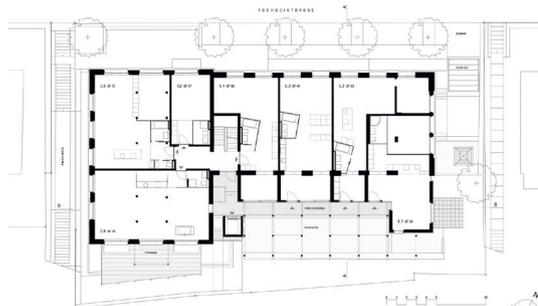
| Solinsieme. Grundriss Erdgeschoß
